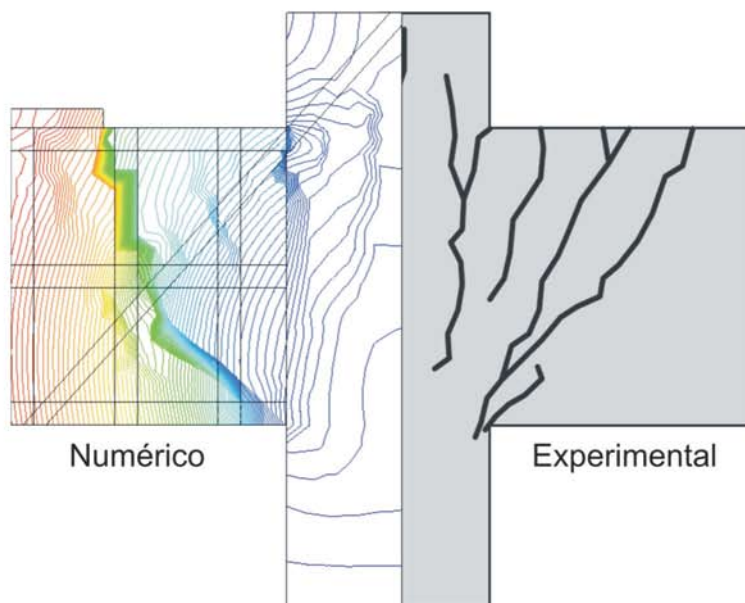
Consolo de concreto armado: padrões de fissuração
